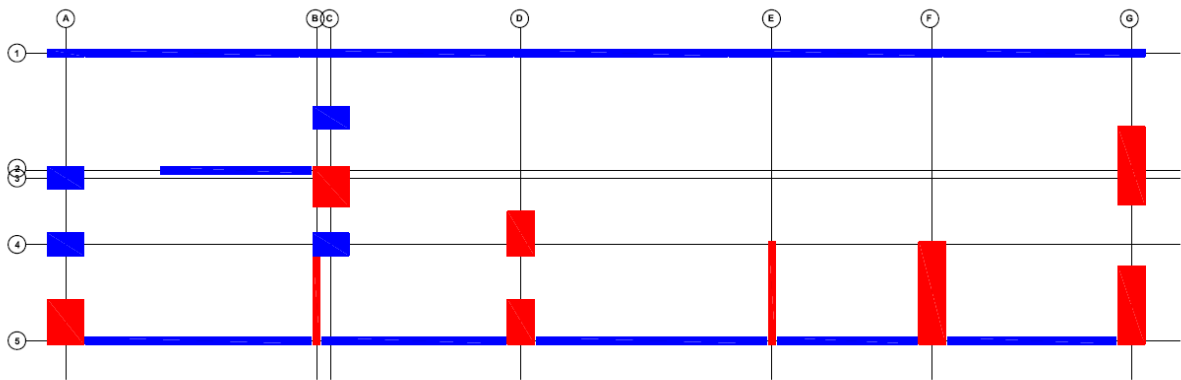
Configuración estructural modificada en planta de muros edificación 1.
